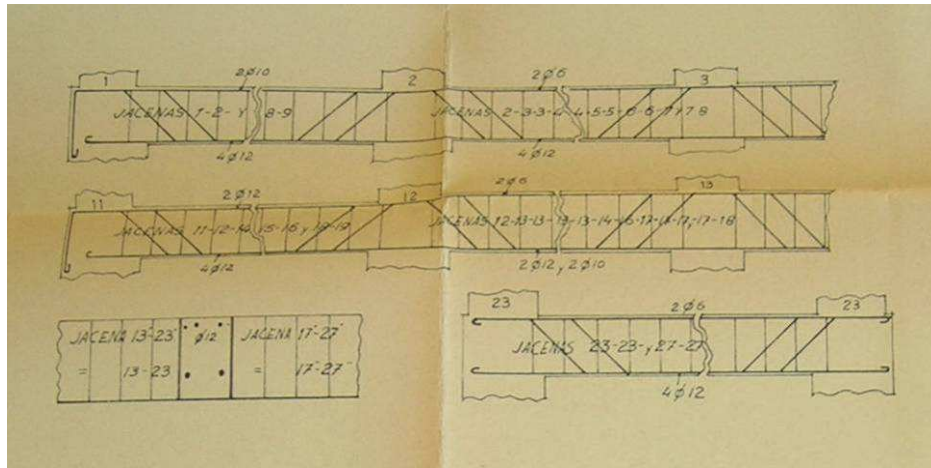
Detalle de armado de viga. Edificio ficha 154^a.009, 1964.
